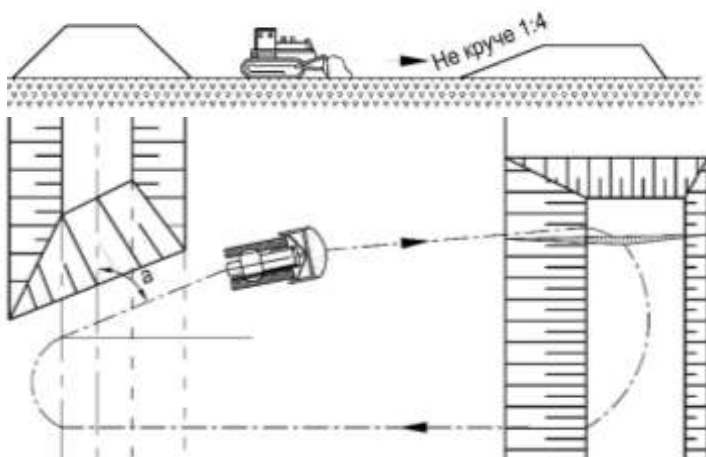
Технологическая схема производства работ по перемещению ранее разработанного грунта
